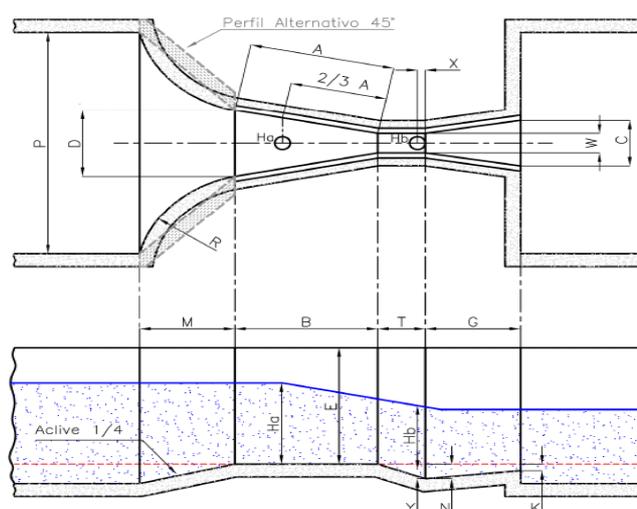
Vista superior e corte longitudinal da Calha Parshall
